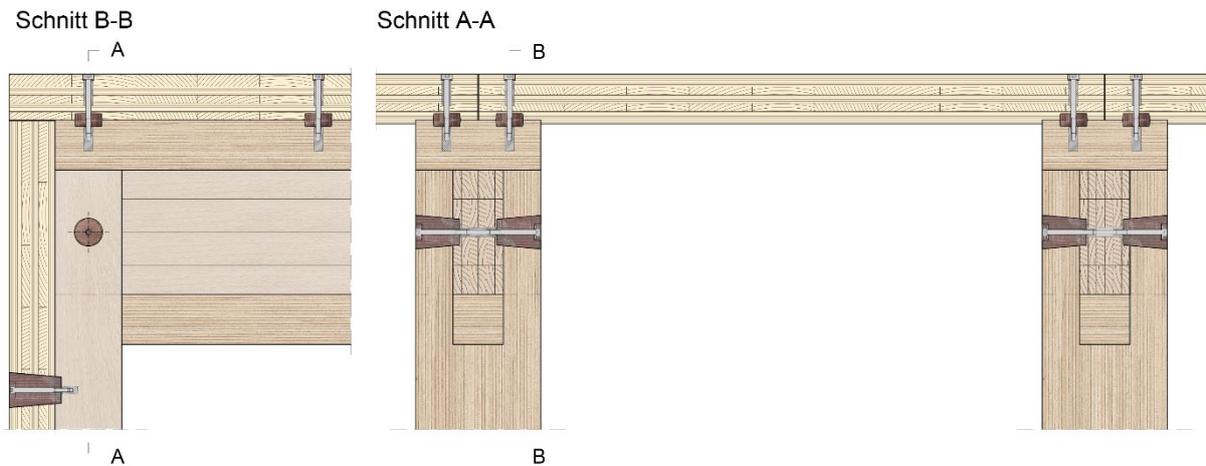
Deckentragwerk mit reversibler Dach- und Wandkonstruktion und reversibler Gabellagerung I-profilierter Träger auf Stützen. Ansicht links; Schnitt rechts [13].
